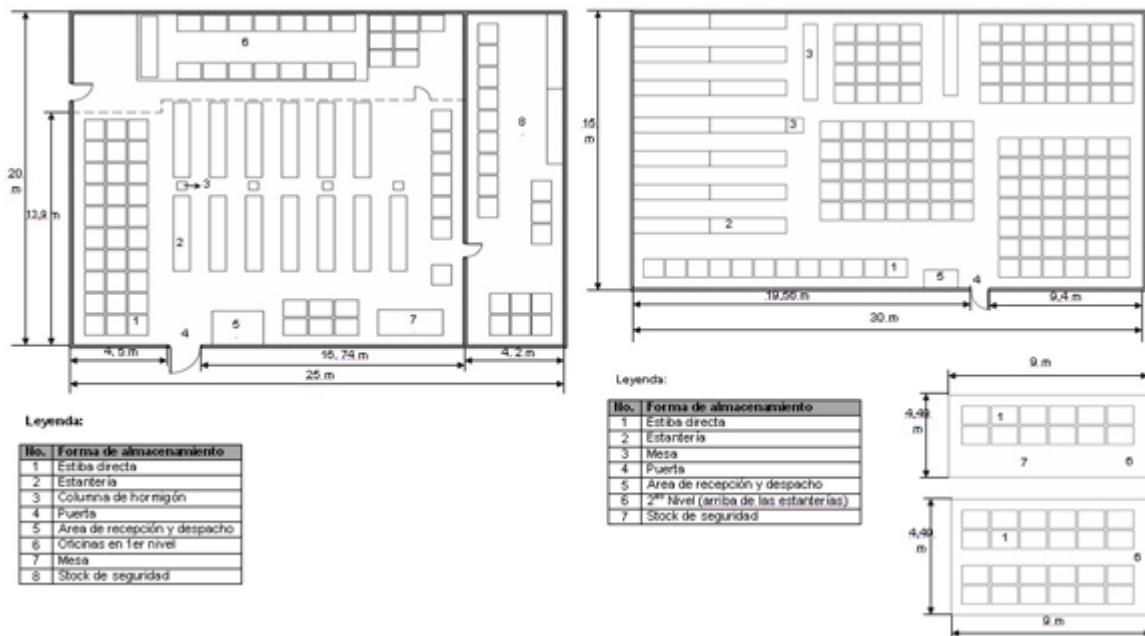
Distribución en la planta propuesta, para las naves 1 y 2
